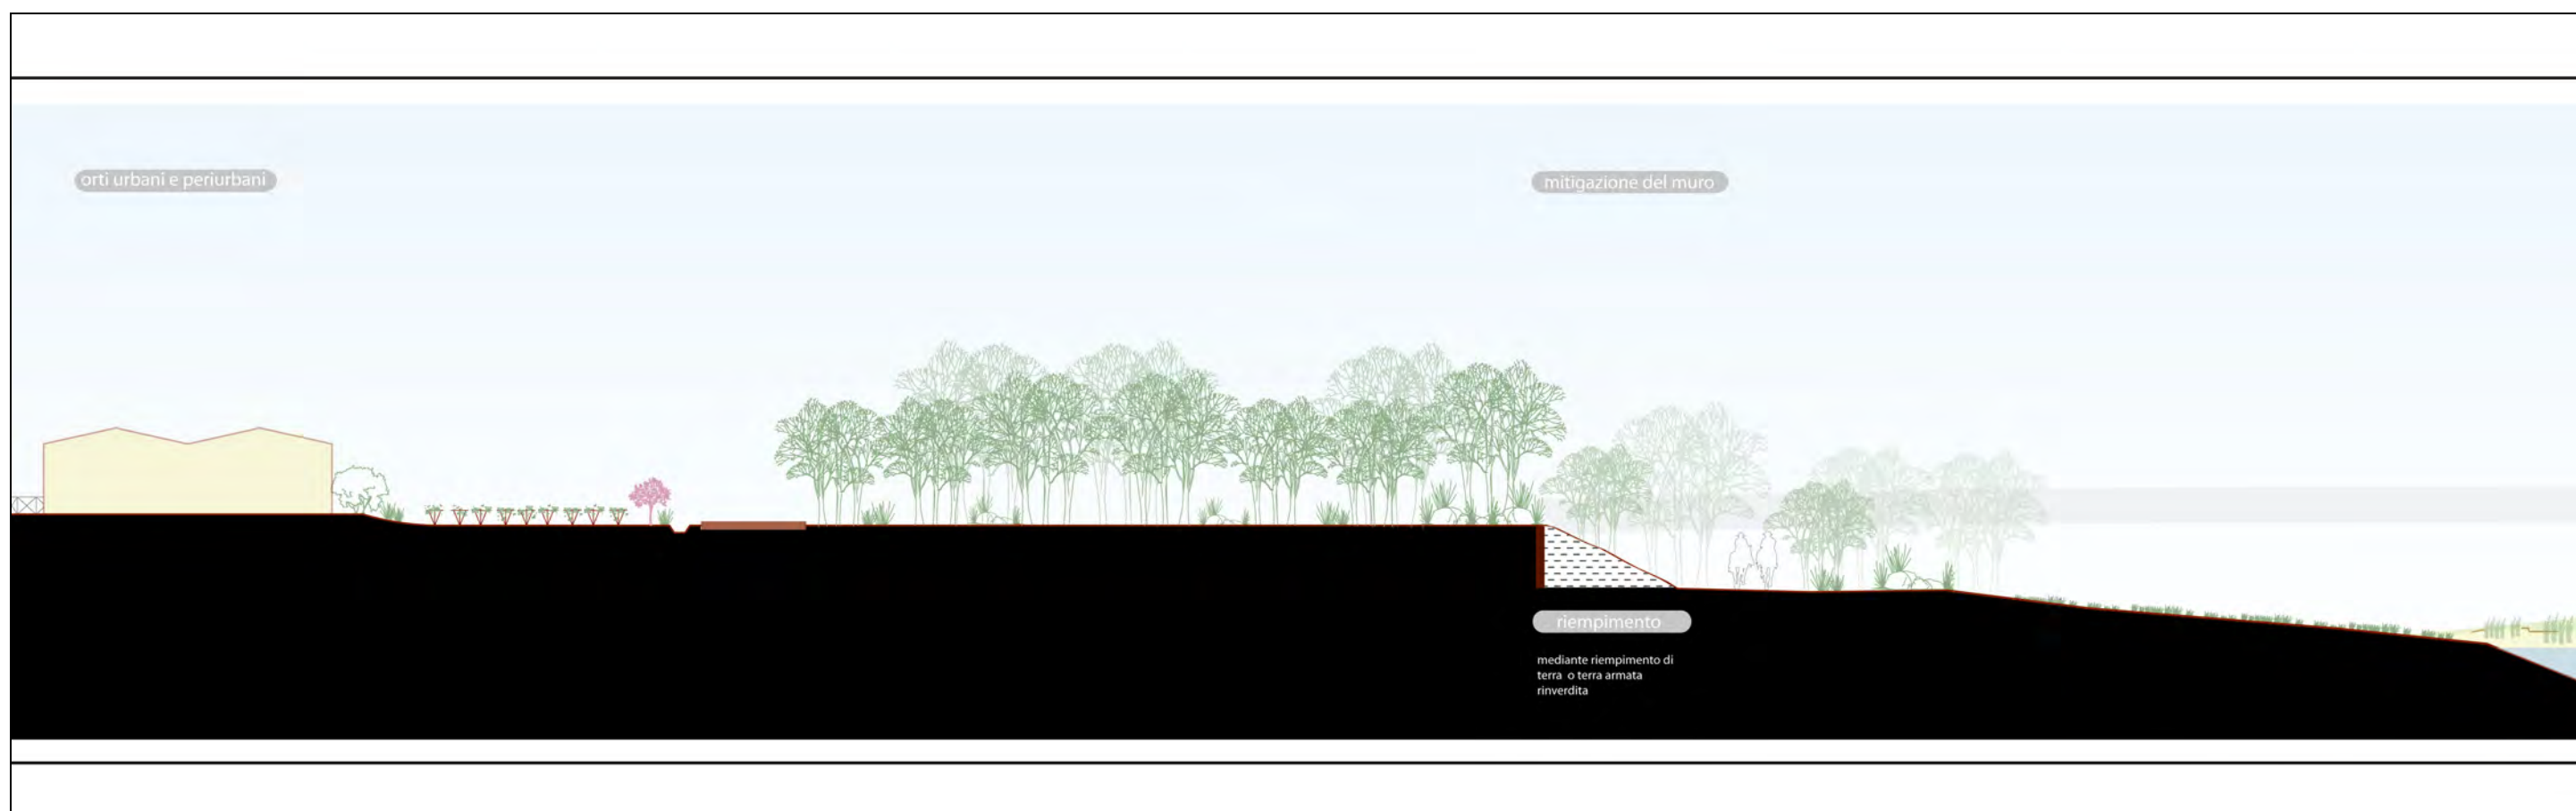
Estratto della sezione nel punto di connessione tra piano campagna e area golenale ove oggi si collocano i muri a retta. In questo caso è stato trattato in modo da mitigare l’impatto con il riempimento.
